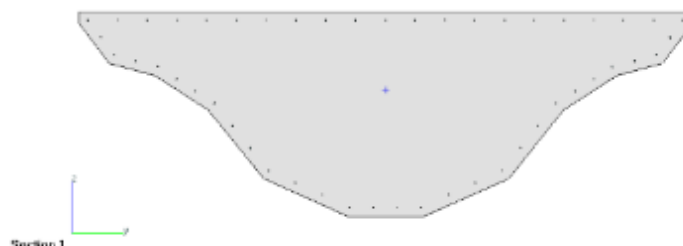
Secção transversal nos apoios com a solução de armadura.
